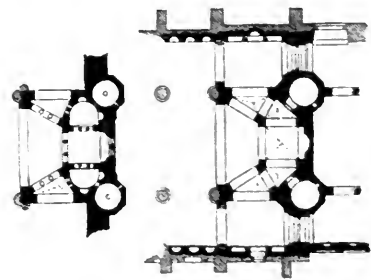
Grundriß vom Erdgeschoß und Empire im Westchor zu Effen.
